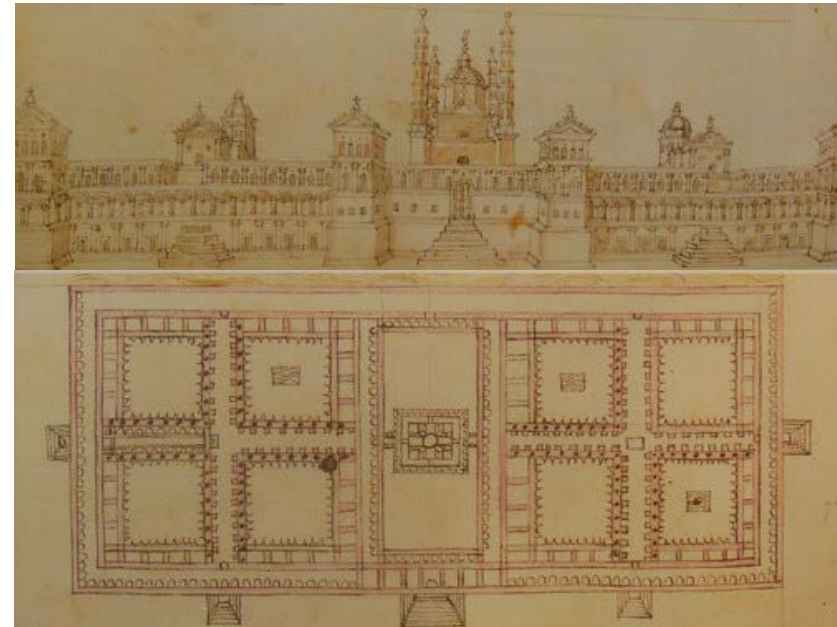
Planta y alzado del Hospital Mayor de Milán del arquitecto Filarete, 1456.
